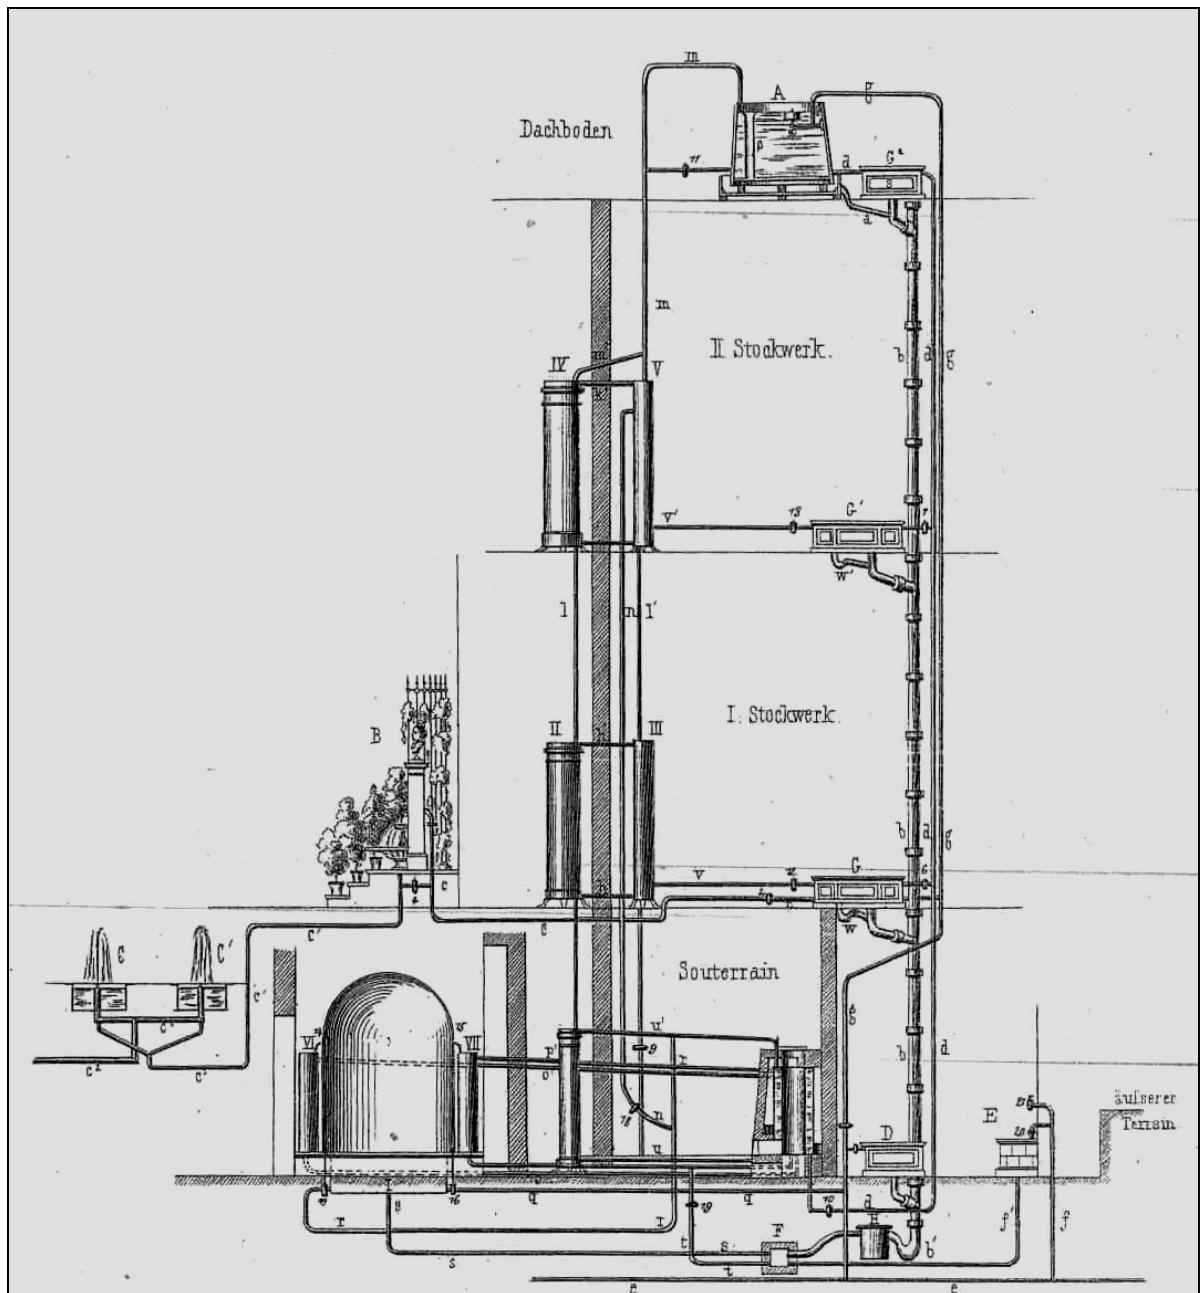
Installationsplan der Wasserleitungen in der Villa Stockhausen, 1855
